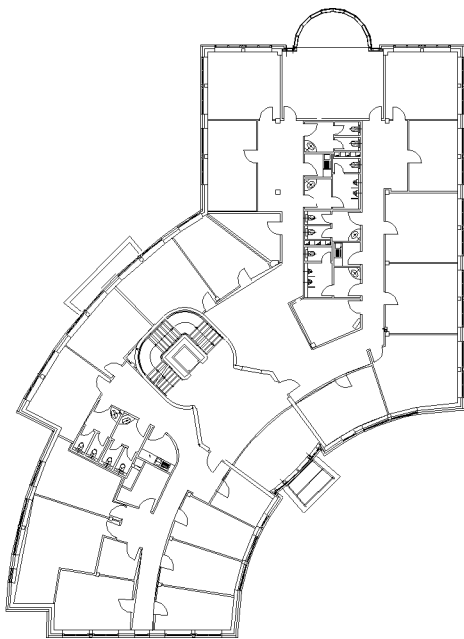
Grundriss, 1. OG, ECOTEC I
